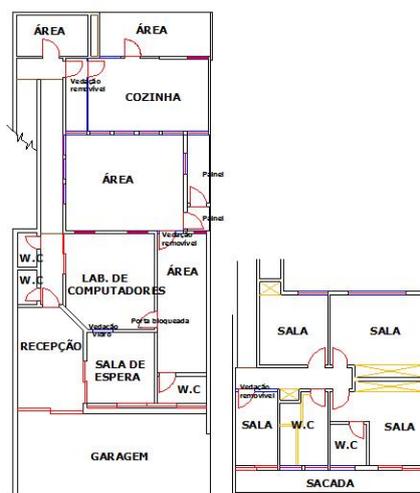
Croqui Planta Atual – Res. Alfredo Fonseca
